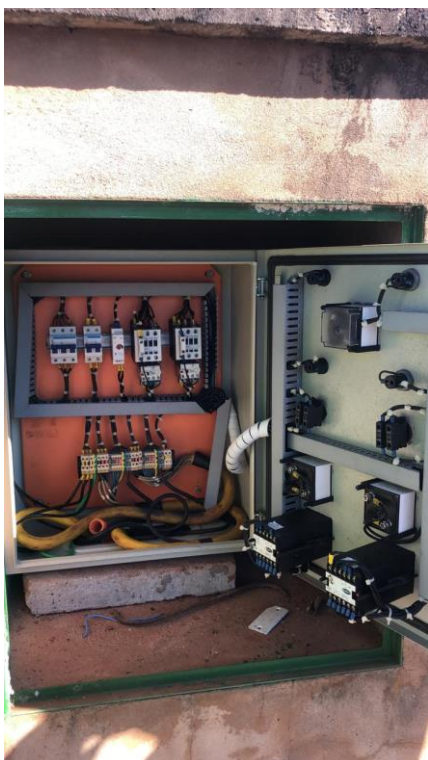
Painel Estação Elevatória de Esgoto - Morada do Campo
